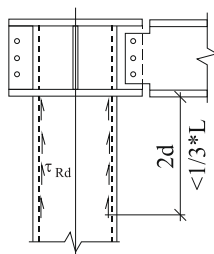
Местное нагружение заполненного бетоном трубчатого сечения (L - высота колонны) (п.6.7.4.2(6) СН РК EN 1994-1-1:2004/2011)
